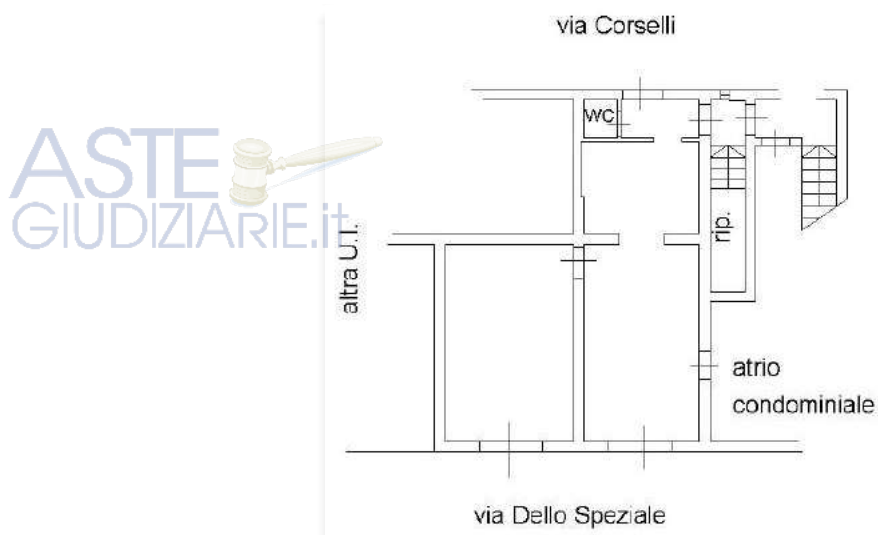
stralcio planimetria catastale depositata nel giugno 2013
